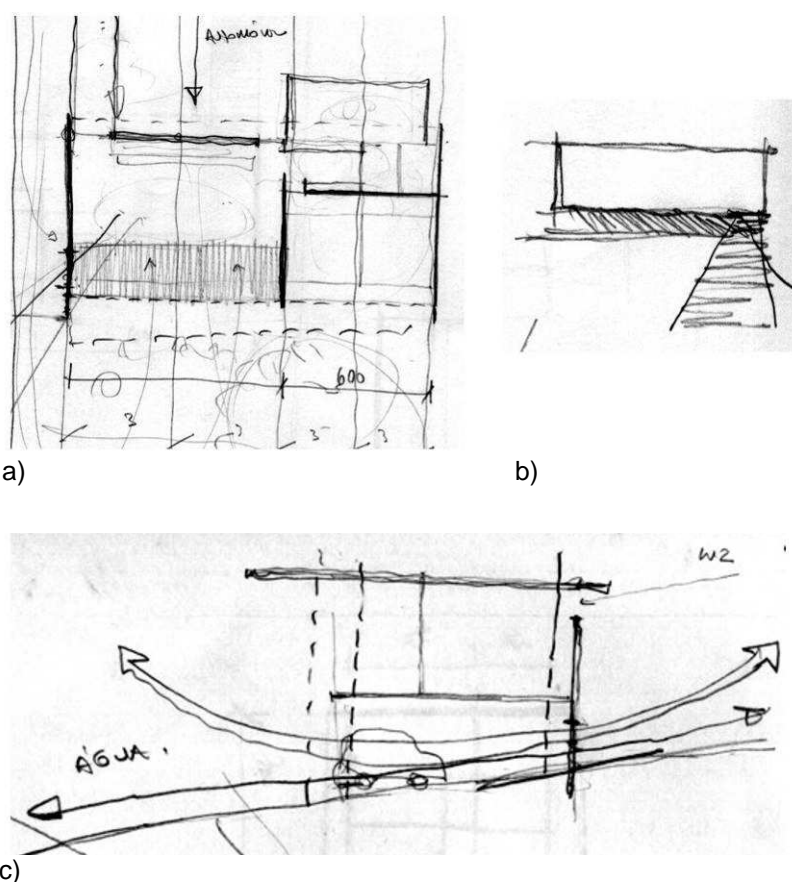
Retomada da proposta do pavilhão único, em planta, corte e elevação frontal, em estágio mais avançado
